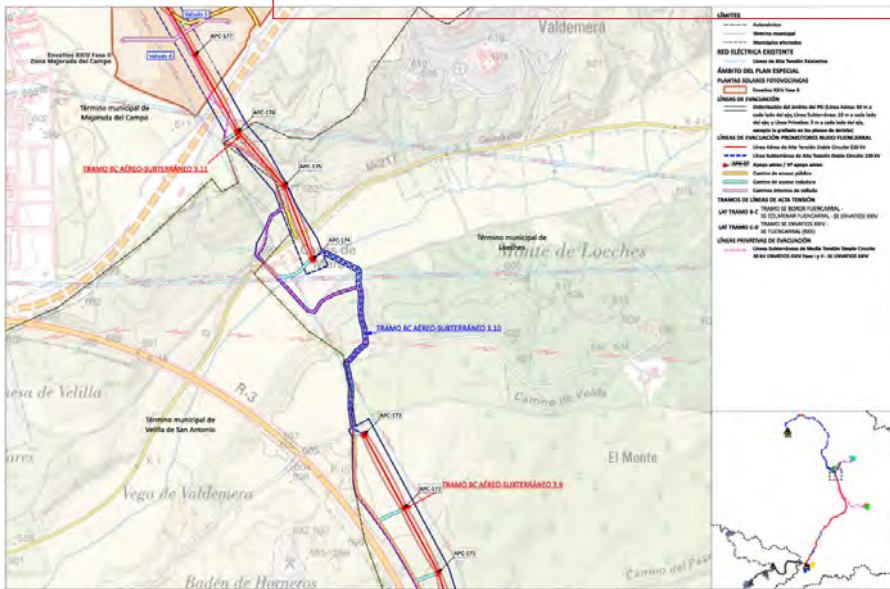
Plano de Ordenación O2.4.8. Planta por tramos. Instalaciones Envatios XXIV
